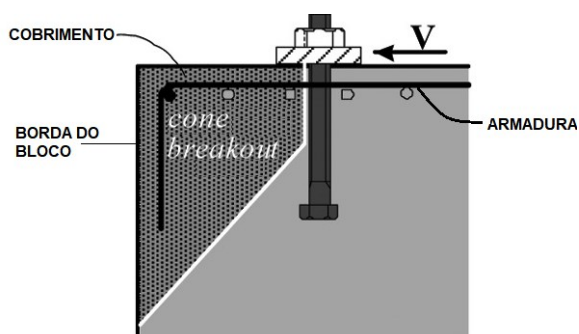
Falha da borda de um bloco de concreto por *breakout* (Petersen e Zhao, 2013)
